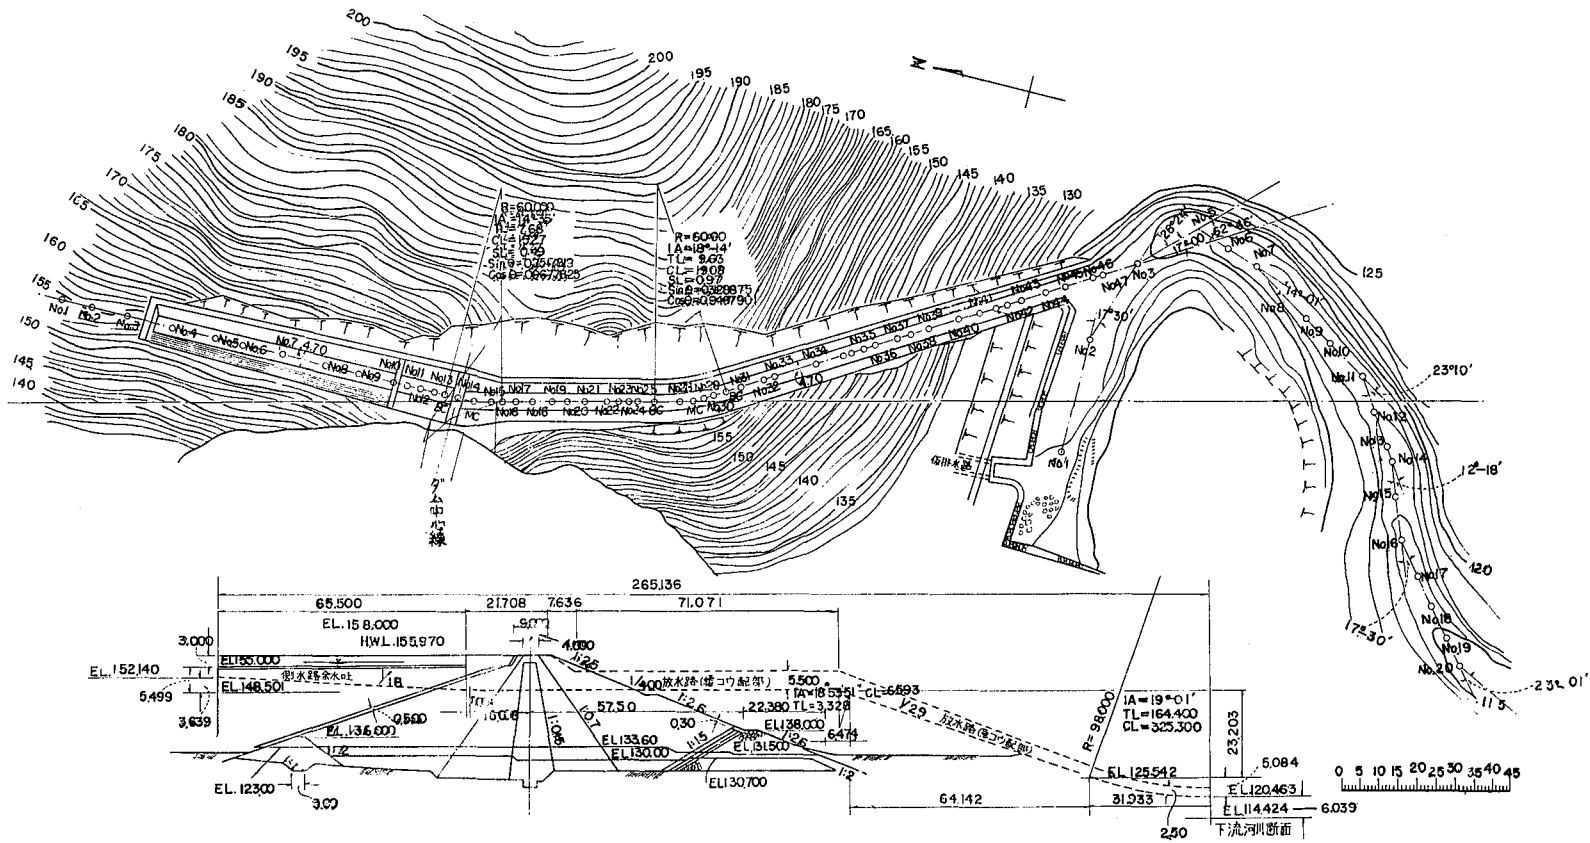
青鹿ダム余水吐一般図 Seiroku earth dam —General layout of spillway
